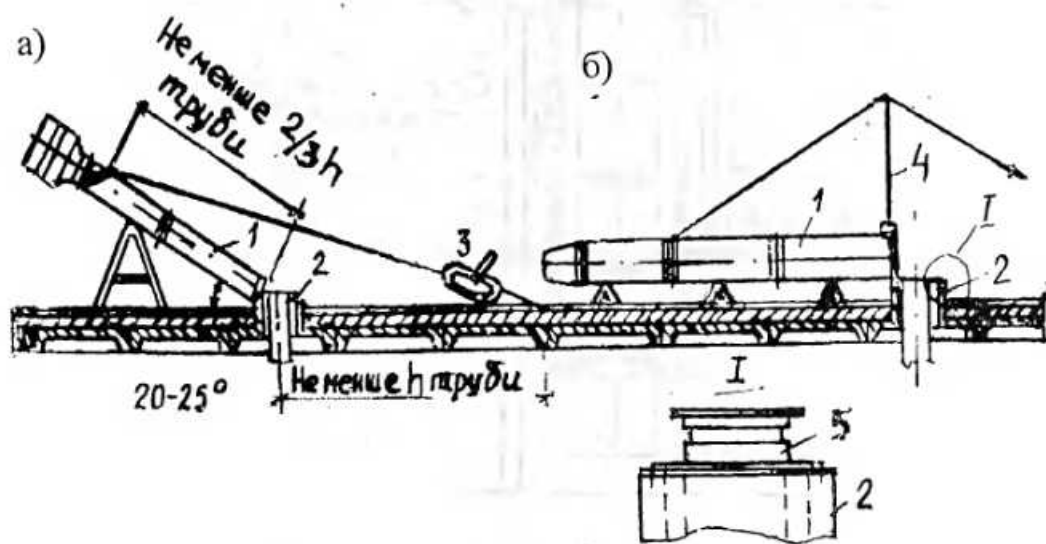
Монтаж вентиляційних труб за допомогою монтажньо-тягового механізму (а) і стійки, яка падає (б): 1 - труба; 2 - стакан; 3 - монтажно-тяговий механізм; 4 - стійка; 5 - патрубок
